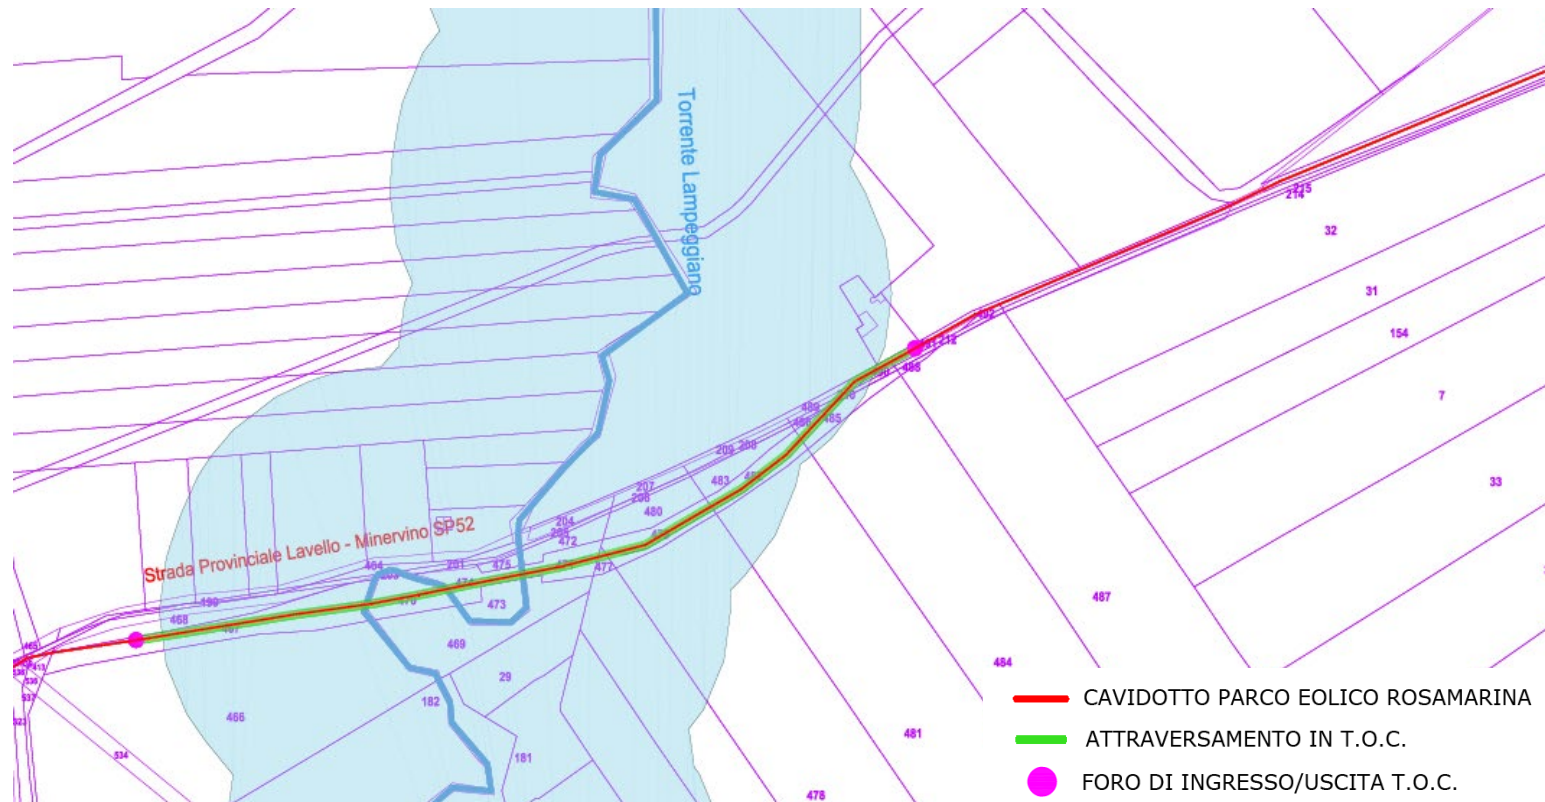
Stralcio planimetrico su catastale con indicazione del tratto di cavidotto da realizzare in T.O.C in corrispondenza del torrente Lampeggiano
